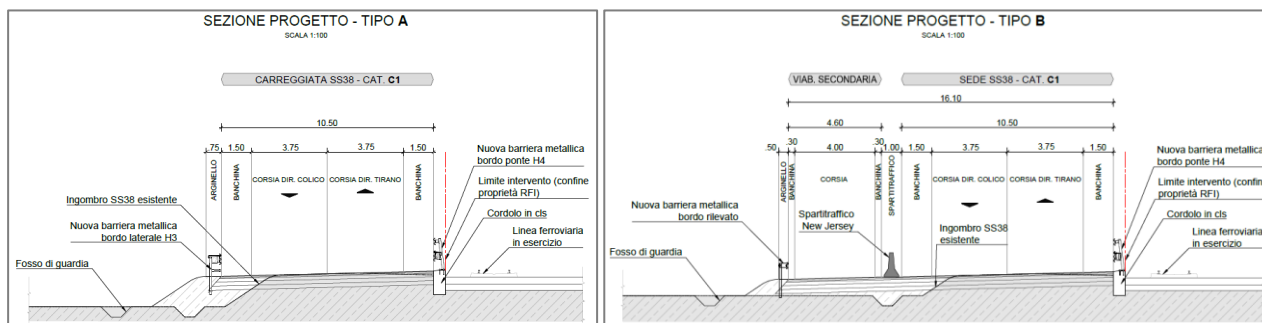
Tipologia di adeguamento alla sezione stradale tipo C1 previste in progetto.
